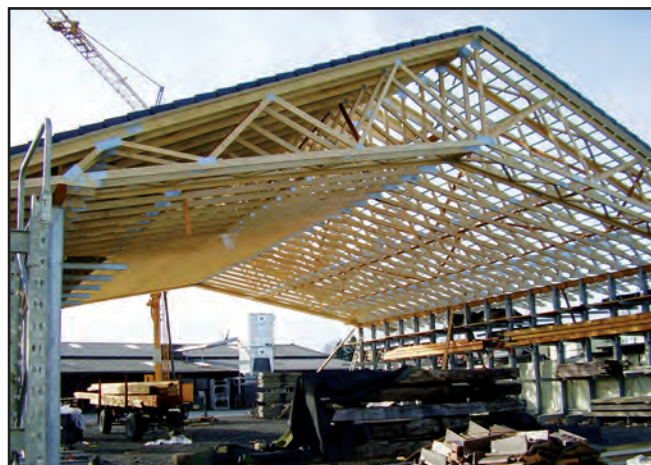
Dachkonstruktion mit Nagelplattenbindern.
